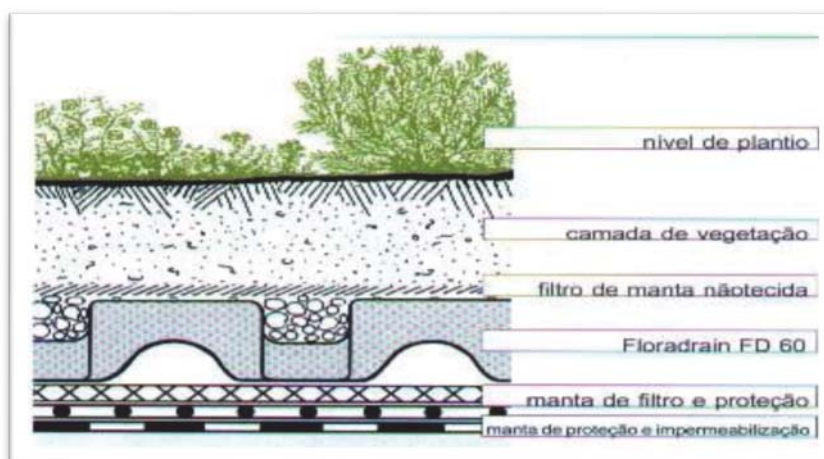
Estrutura do Telhado Verde (Fonte: Zinco, 2000)
